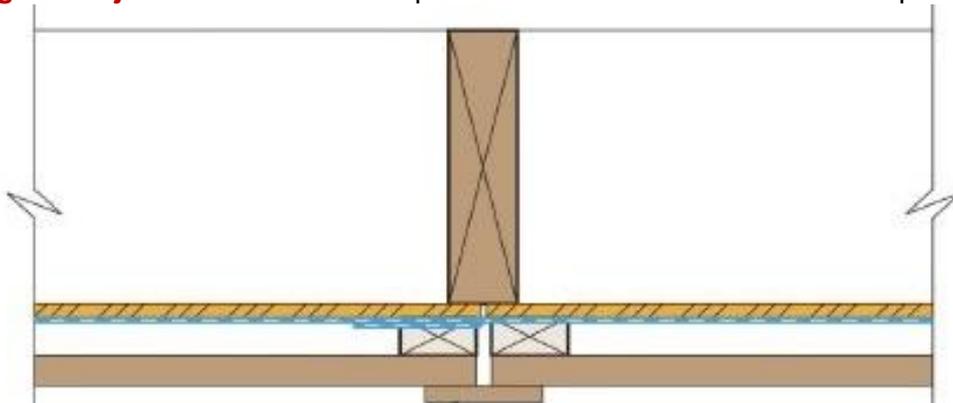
Simple recouvrement à sec derrière un bardage à joints fermés (coupe horizontale)
